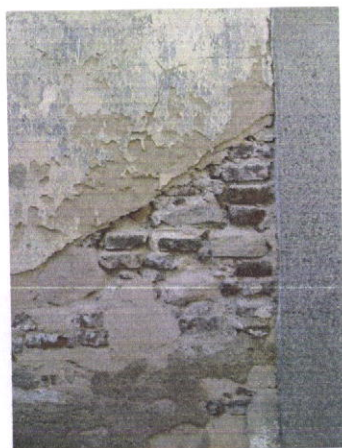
e 7.6 – Tijolo burro utilizado na construção das paredes.
